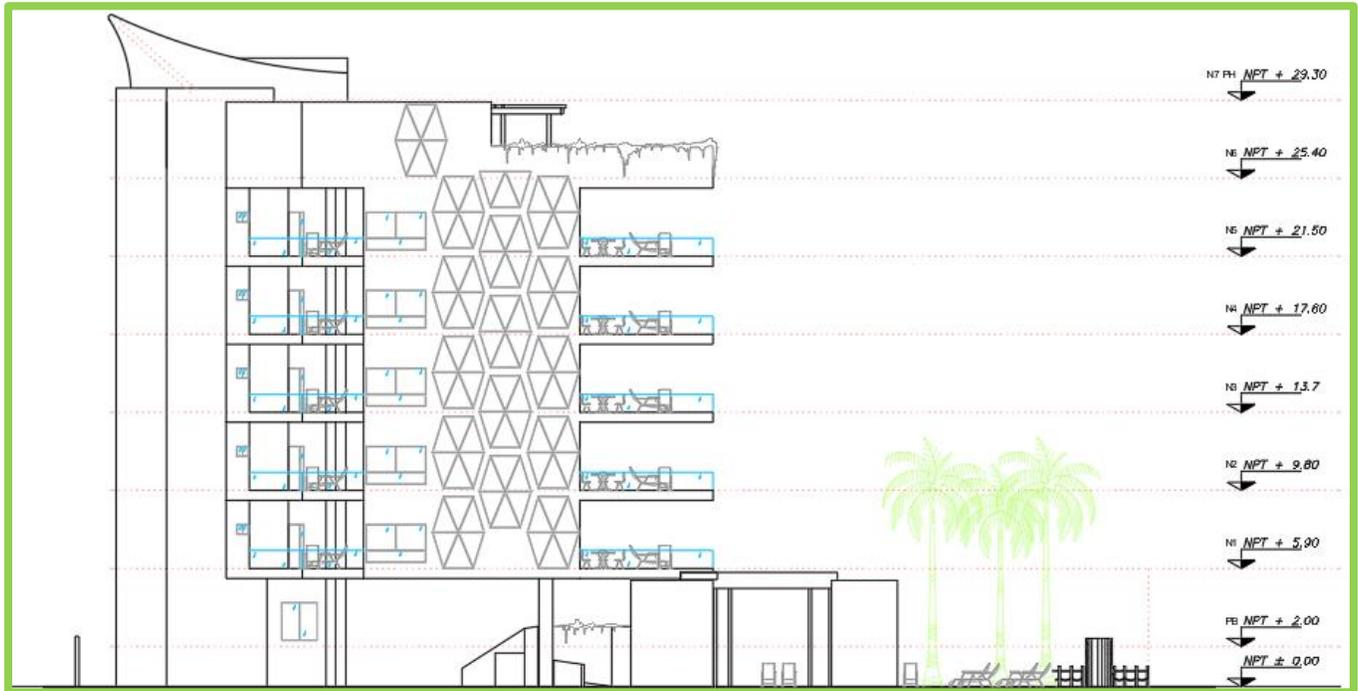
Detalle del diagrama del polígono Corte Fachada Principal
